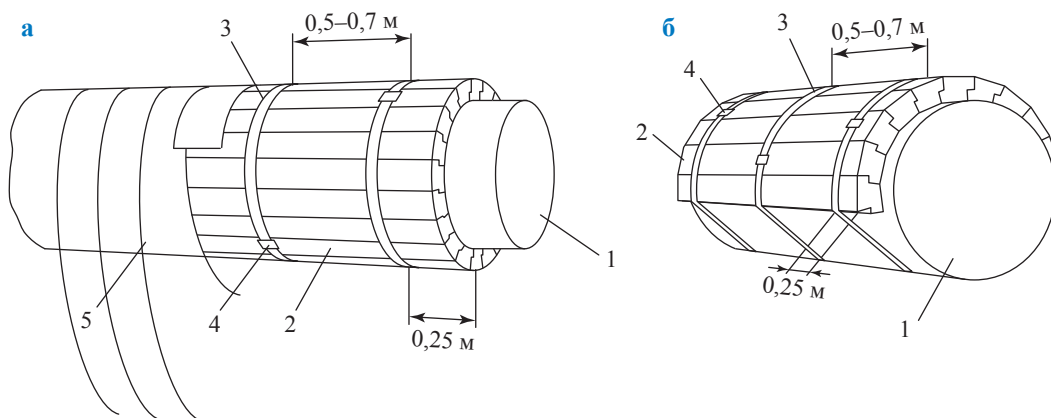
Схемы кольцевой теплоизоляции трубы (а) и теплоизоляции верхней половины трубы (б): 1 – магистральный газопровод; 2 – сегмент теплоизоляции; 3 – стальная или пластиковая полоса; 4 – фиксирующий элемент; 5 – покрытие из полимерных лент
